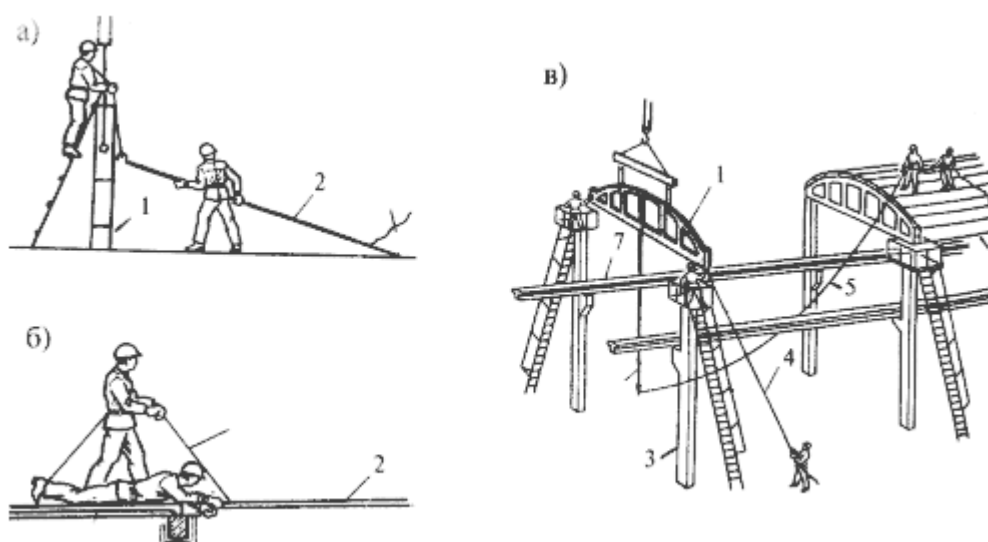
Применение фиксирующей распорки для временного крепления стропильной фермы
